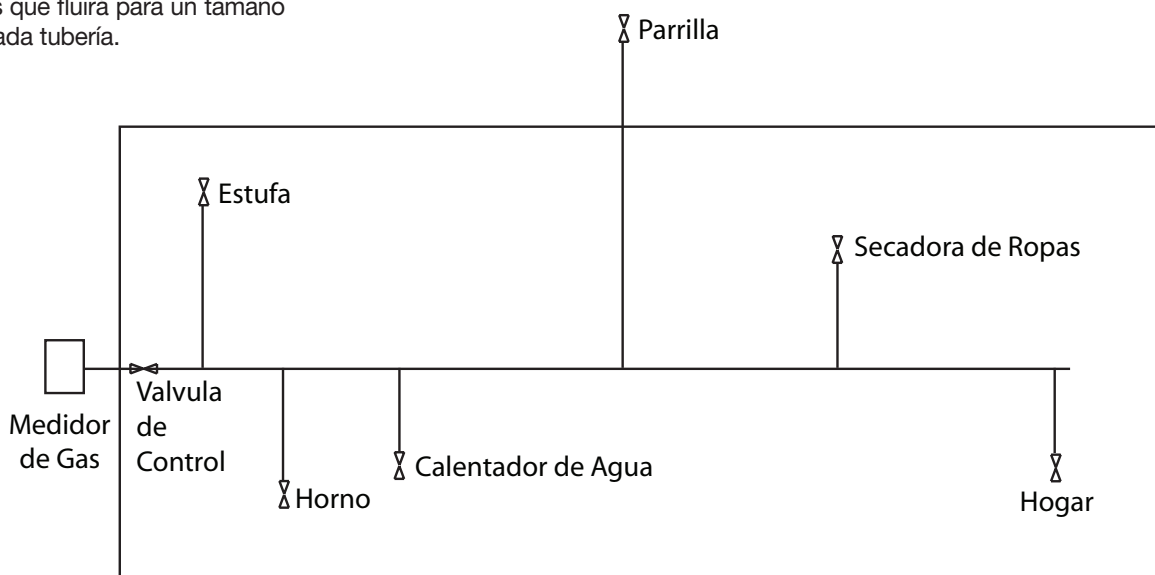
Plan de tubería residencial típica con sistema ramificado
